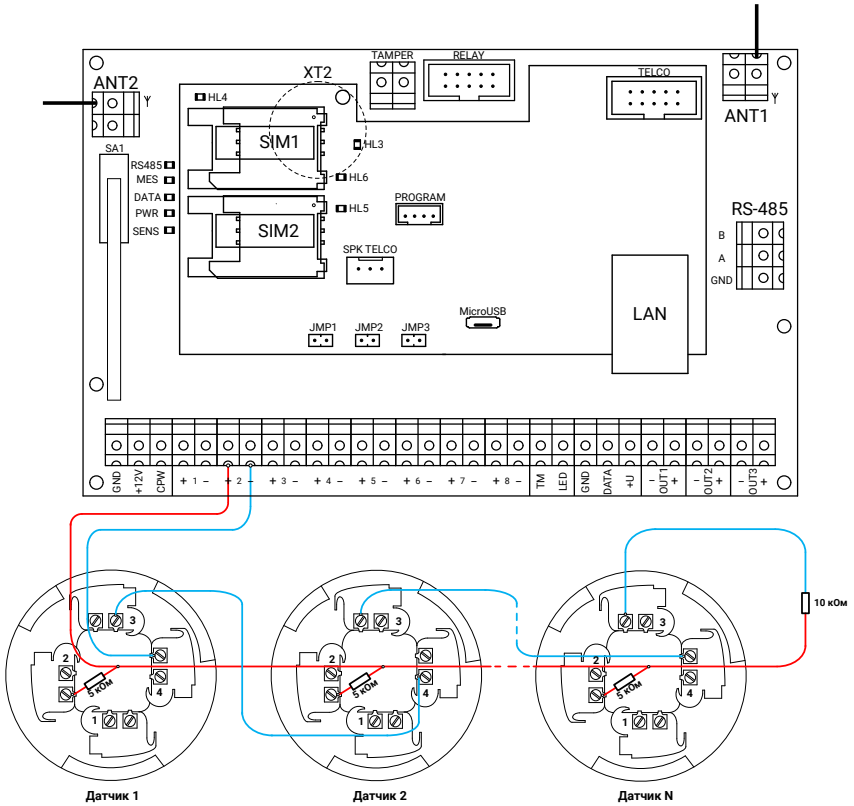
Схема подключения пожарных шлейфов с контролем обрыва
